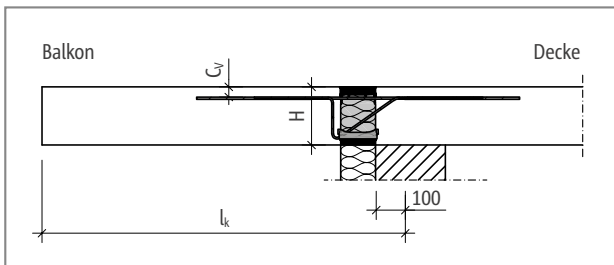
Schöck Isokorb® XT Typ K: Statisches System
